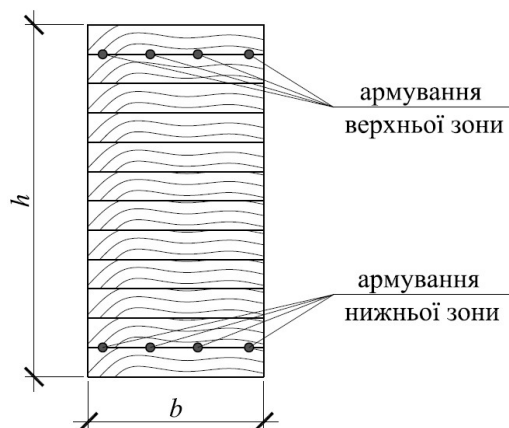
Поперечний переріз елемента з клеєної деревини, армованого композитною арматурою в нижній зоні.
